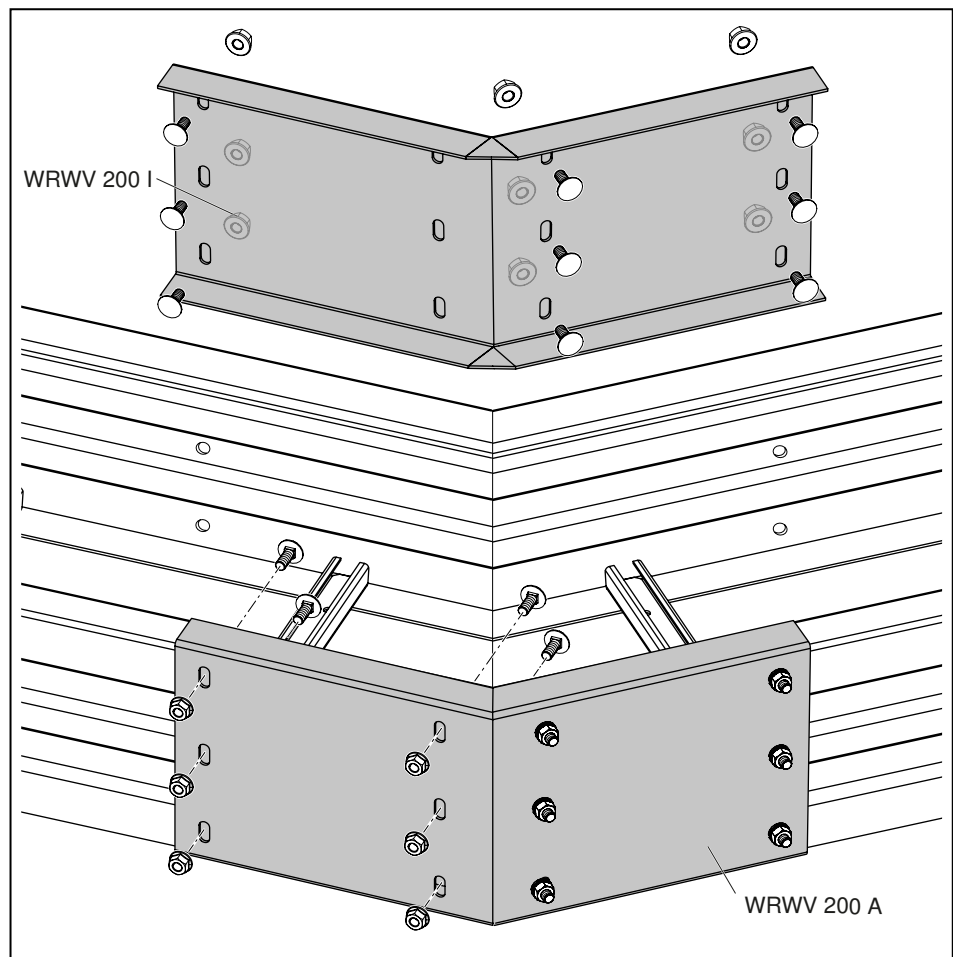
Winkelverbinder WRWV am Innen- und Außenwinkel anschrauben
